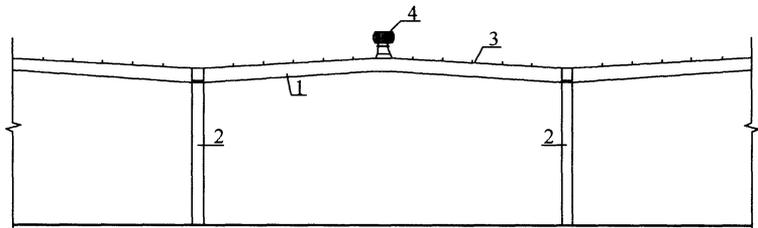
带点式排气帽的钢筋混凝土单层框(排)架结构
